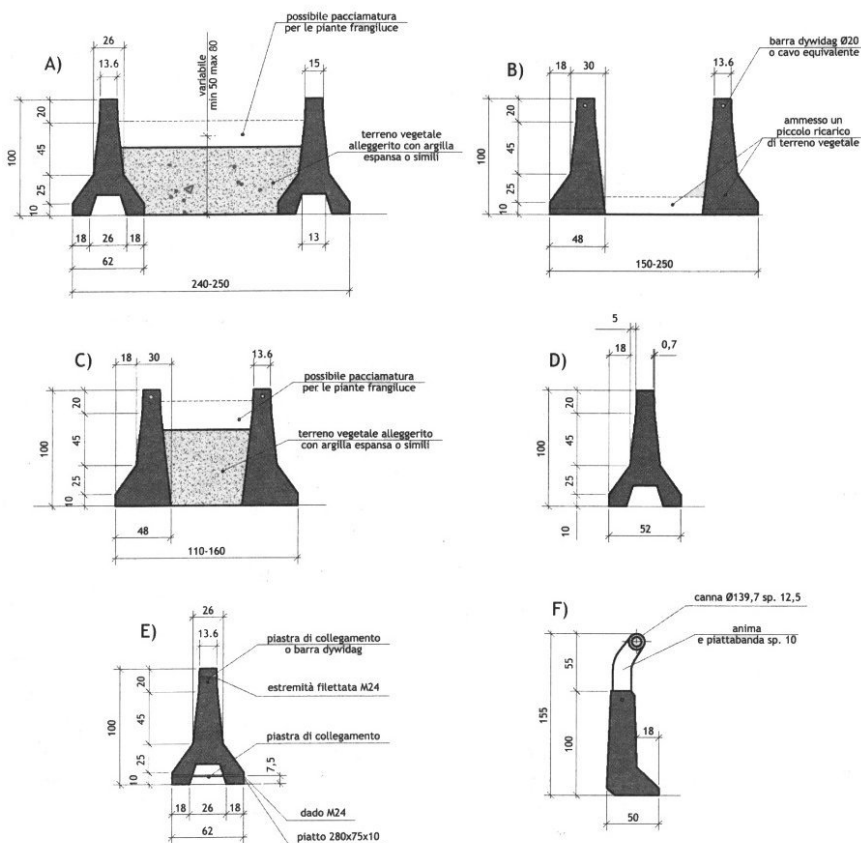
Barriere in calcestruzzo (New Jersey)
